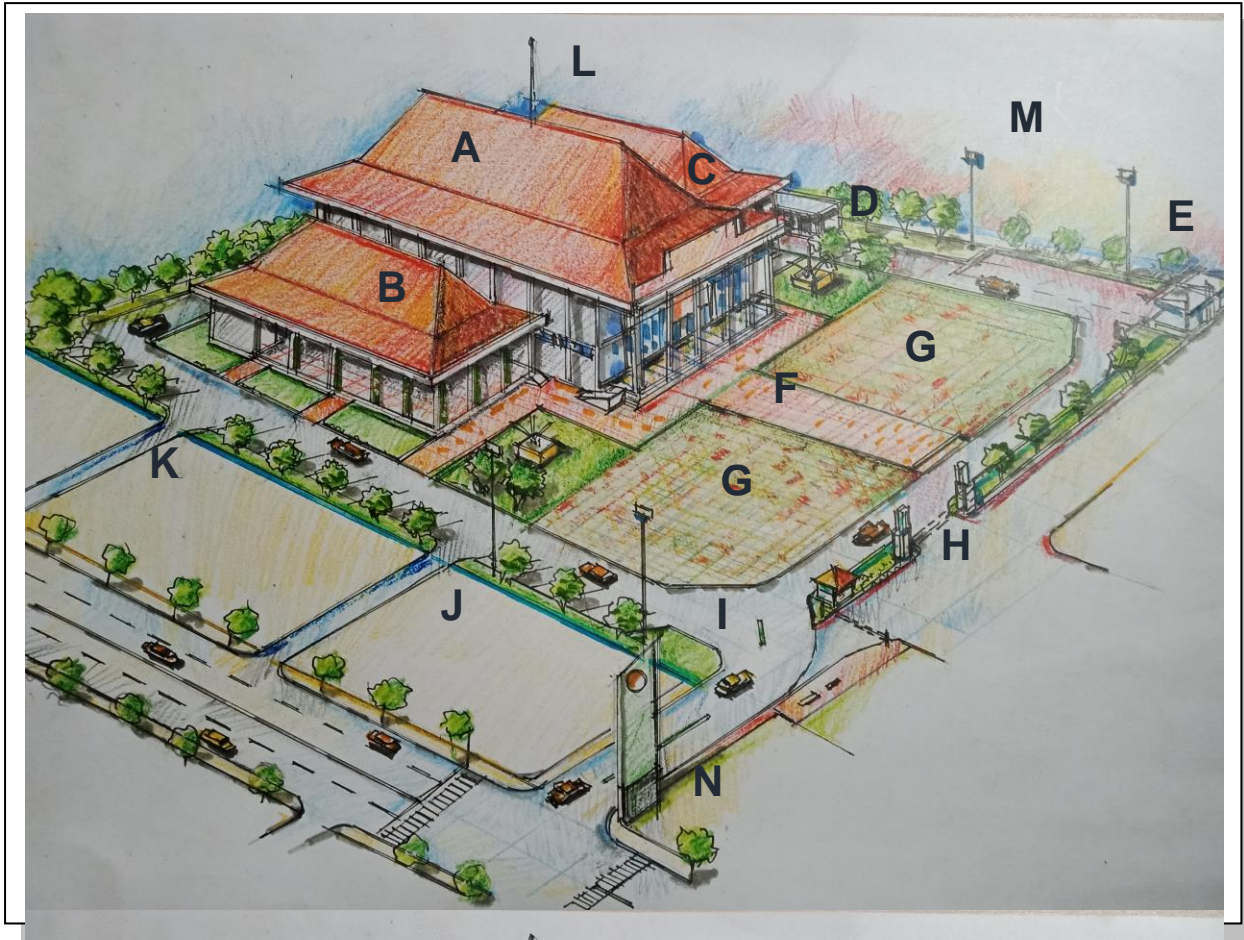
Penataan Tapak dan Bangunan (Site Plan)
